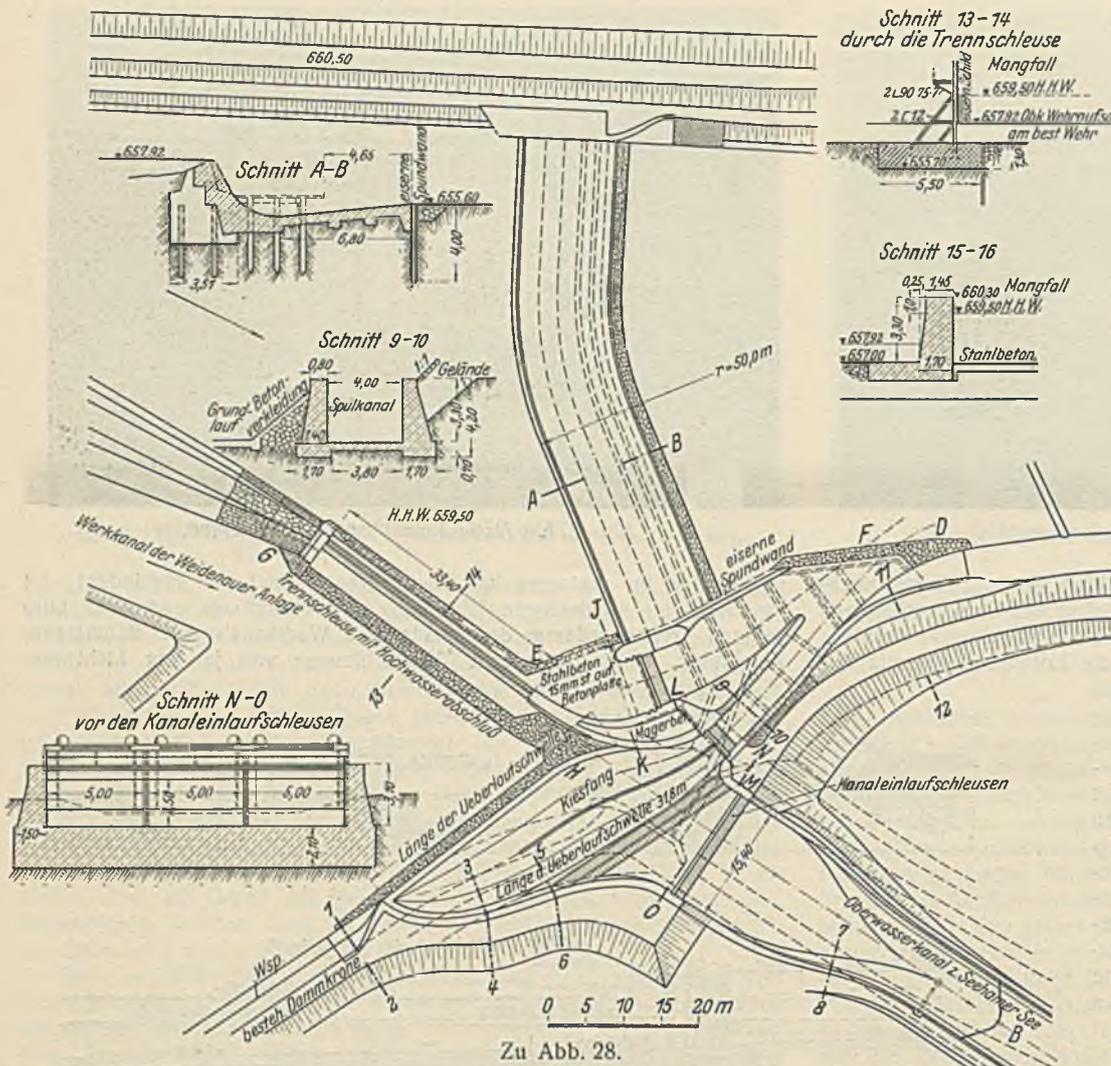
Mangfallwehr mit Einlaufbauwerk.
